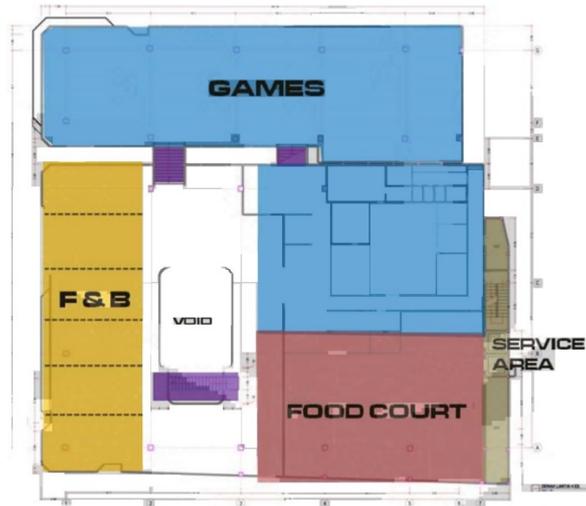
Denah Lt.2 alternatif konsep pengembangan Mal Mitra 2
